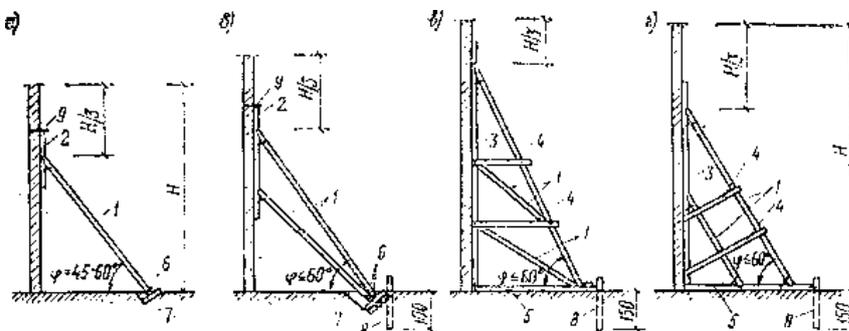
Схемы крепления отклонившихся и выпучившихся стен подкосами
